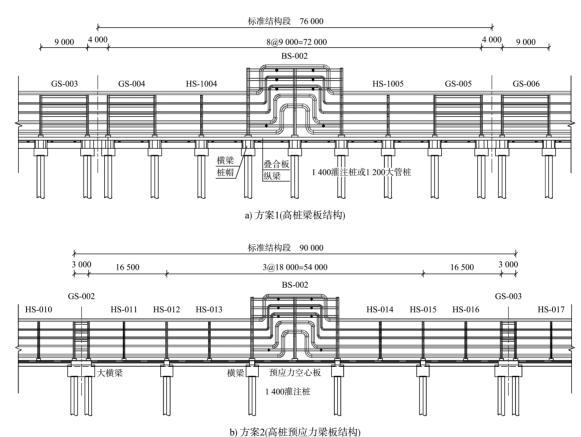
公共管廊立面 (单位: mm) Fig. 4 Elevations of public pipe gallery (unit: mm)
